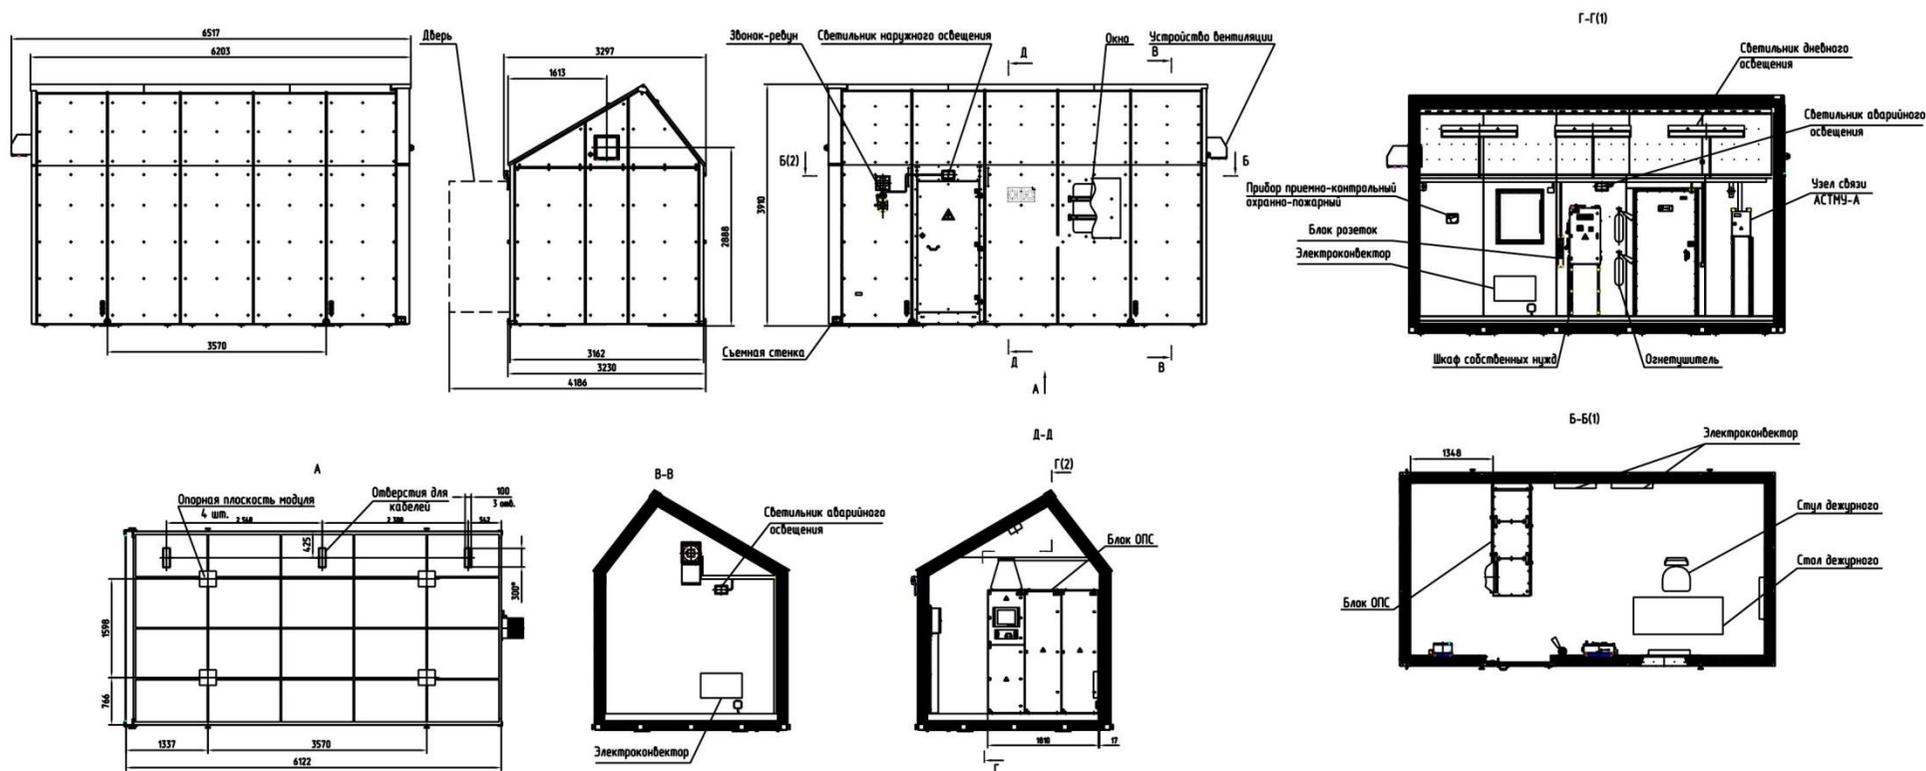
Габаритный чертеж модуля ОПС
